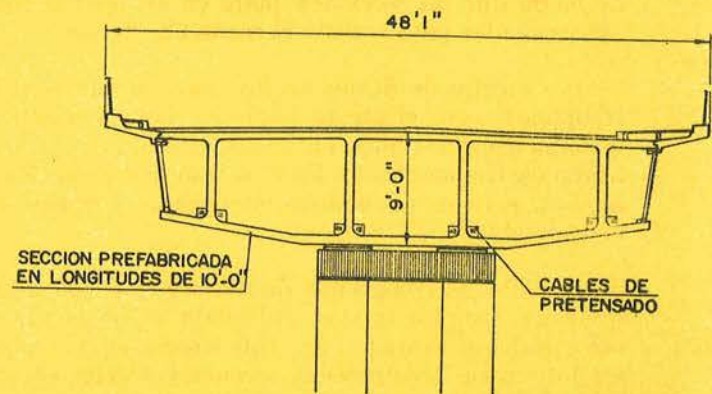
Pueno de la Avenida de la Commonwealth. Sección transversal del tablero. Vano mayor, 240 pies (73,15 m).
